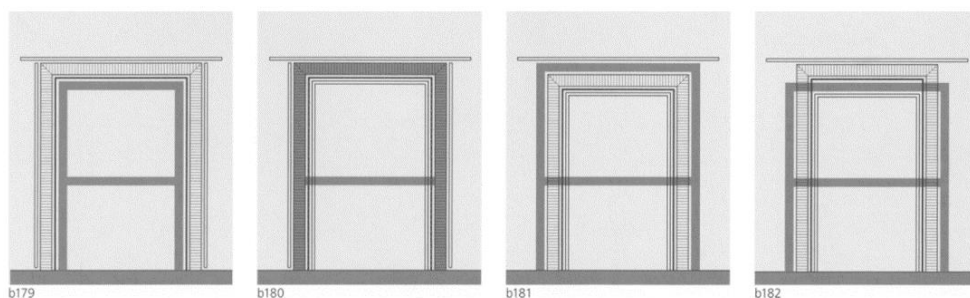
Formas de solução de integração da envolvente construída na estrutura porticada (Kolb, 2008) . Sistema de isolamento pelo exterior, sistema de isolamento entre a estrutura, sistema de isolamento pelo exterior e sistema híbrido.
